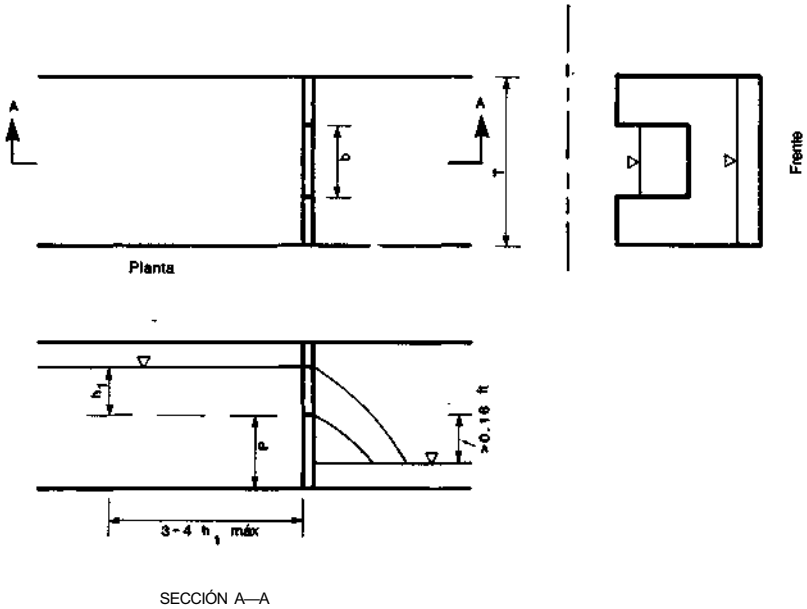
Vertedor rectangular de cresta delgada.
